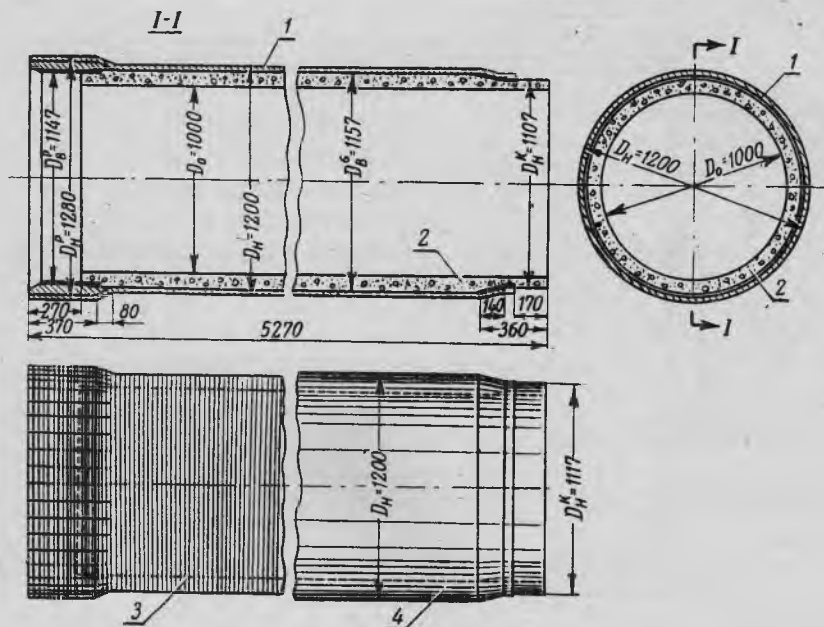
Напряженно-армированная железобетонная труба диаметром 1 м со стальным цилиндром конструкции Водоканалпроекта для напора 10 атм:
